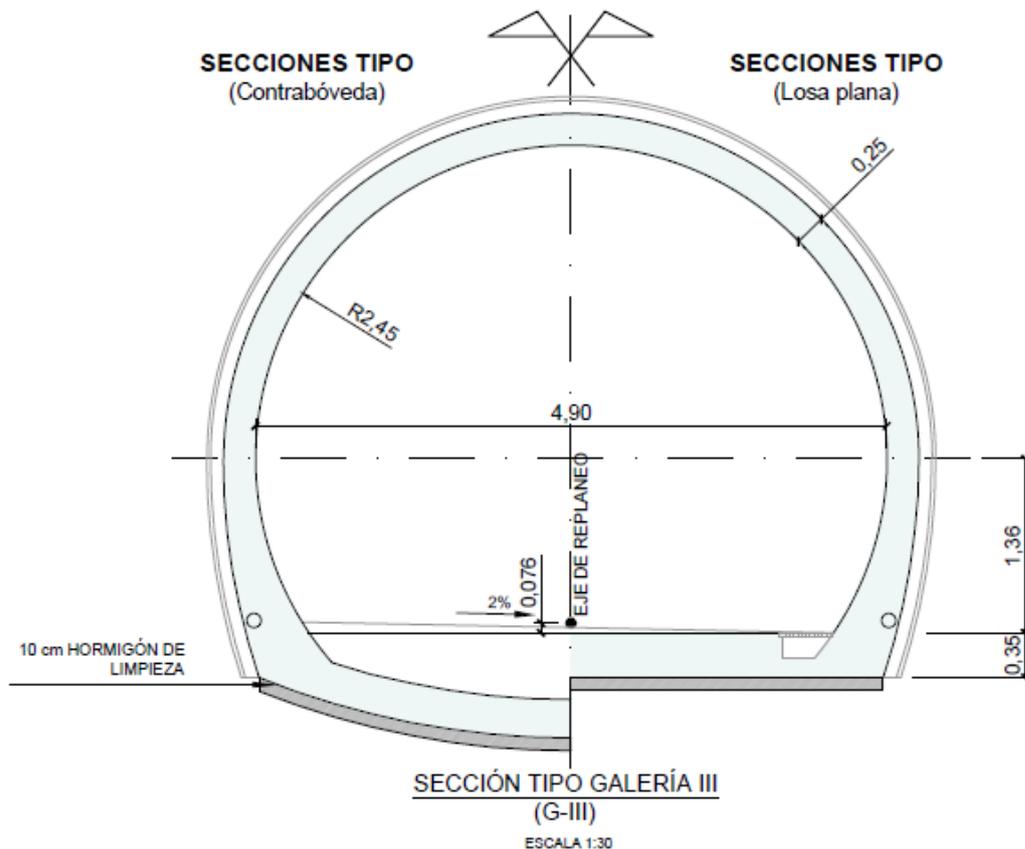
Sección tipo galería de evacuación. (Fuente: Proyecto Constructivo del Acceso Ferroviario al Puerto de A Coruña en Punta Langosteira)
